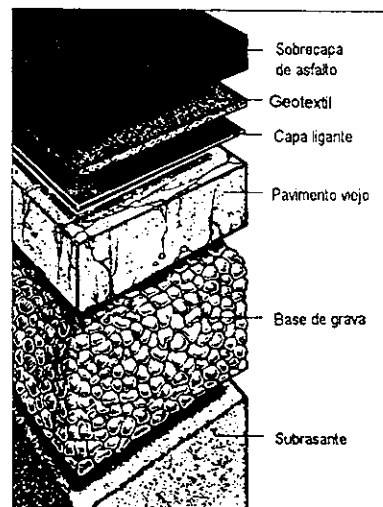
Pavimento asfáltico reconstruido y rehabilitado con geotextil
